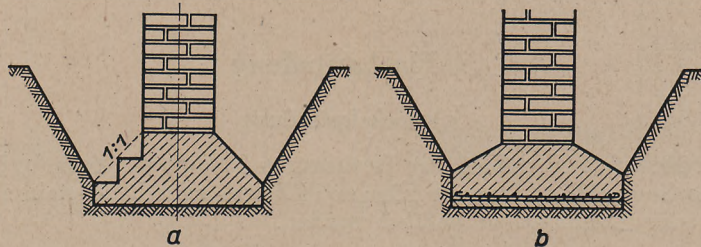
Sockelfundamente in a) Beton und b) Stahlbeton
